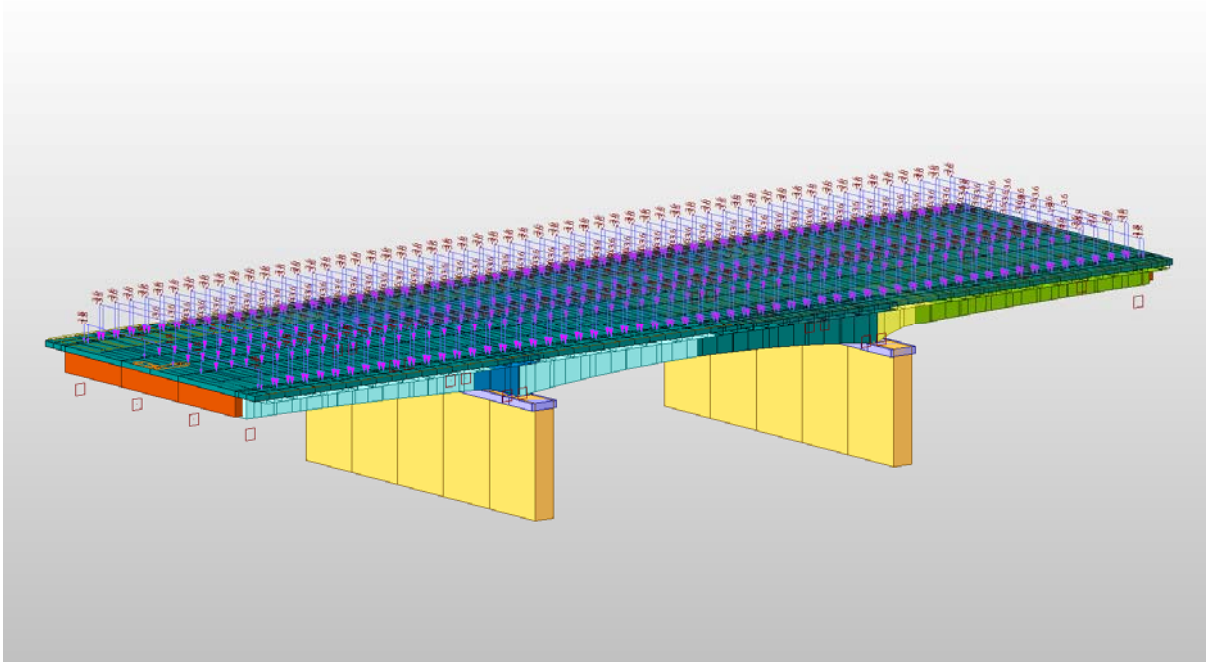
Il peso della massicciata e della pavimentazione stradale
